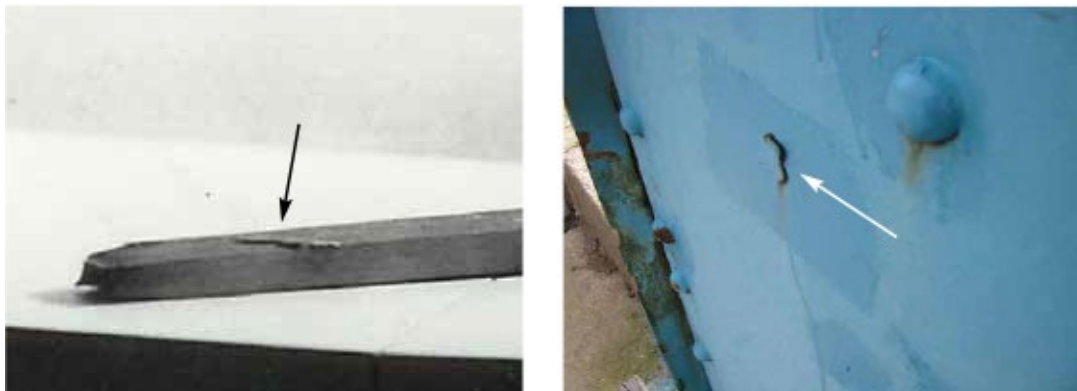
Pailles sur éprouvette d'essai et sur ouvrage (photo Jean-Paul PERSY).
